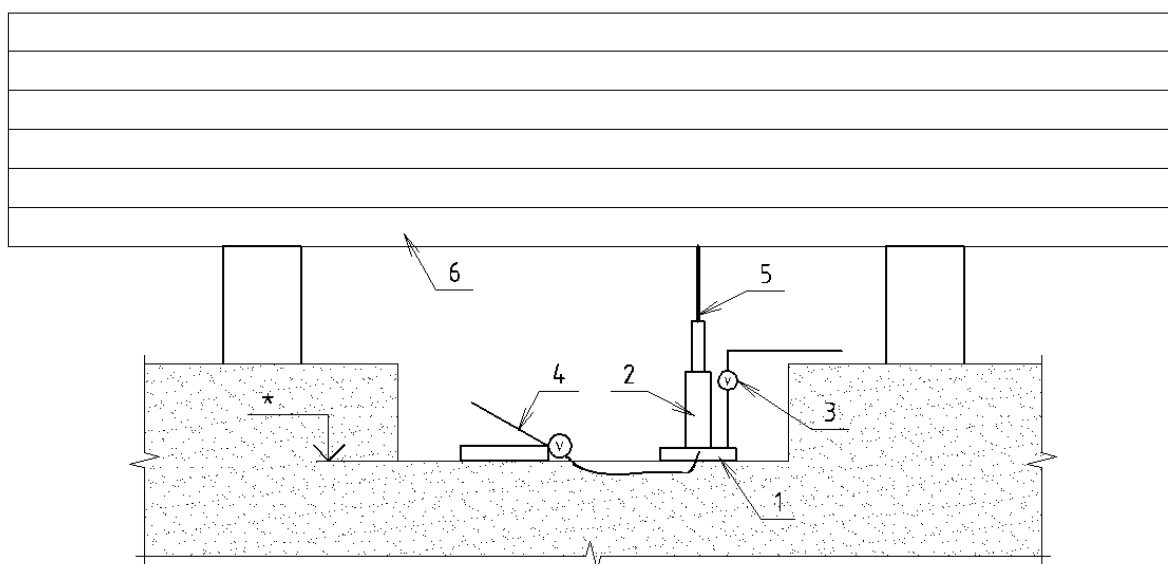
Схема выполнения испытаний грунтов штампом
